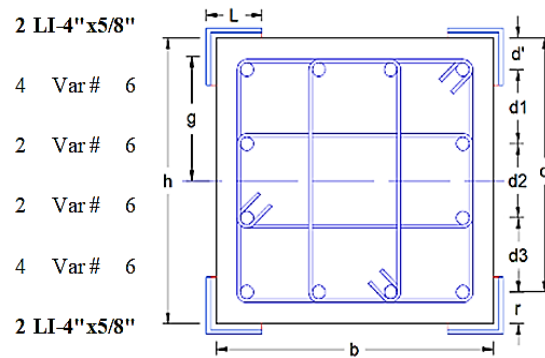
Configuración del armado y refuerzo estructural de la sección.
